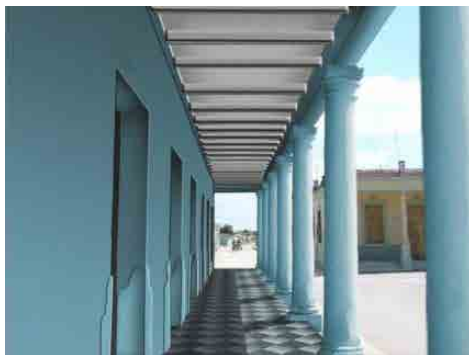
(Derecha) Propuesta y Solución. Viviendas Baire # 24, 26, 28 y 30. Fuente: Autoras
